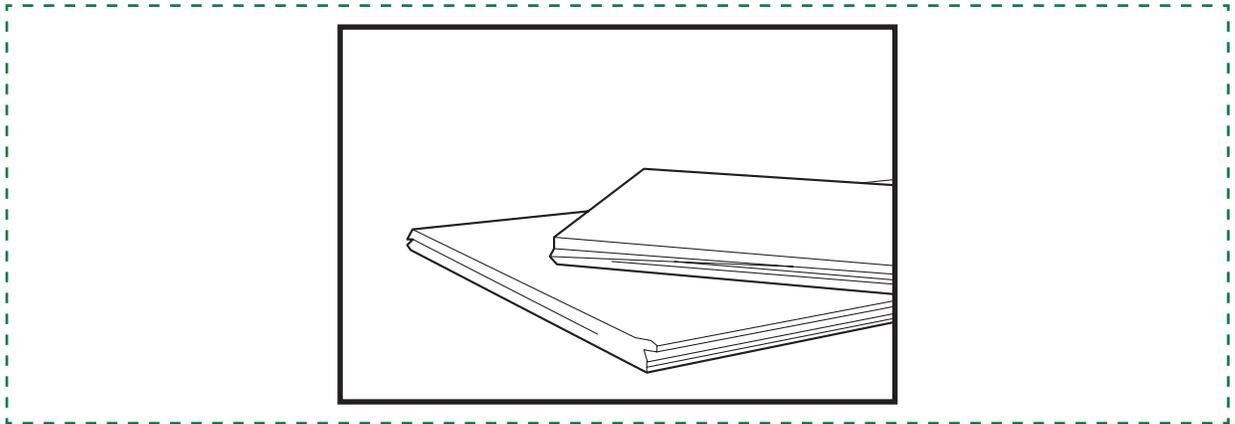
Lana de vidrio, construcción de viviendas en madera
